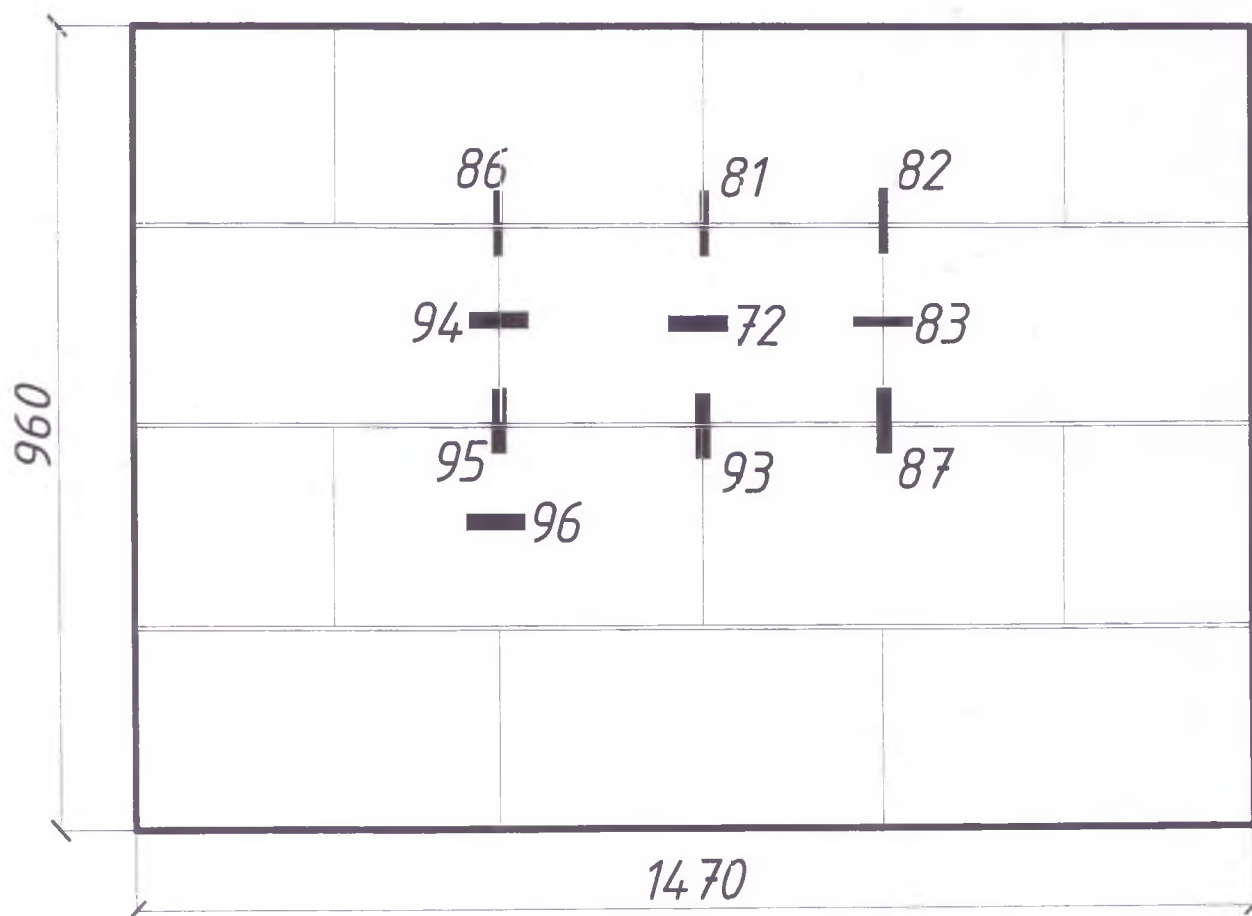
Схема размещения тепломеров на внутренней поверхности кладки фрагмента стены
